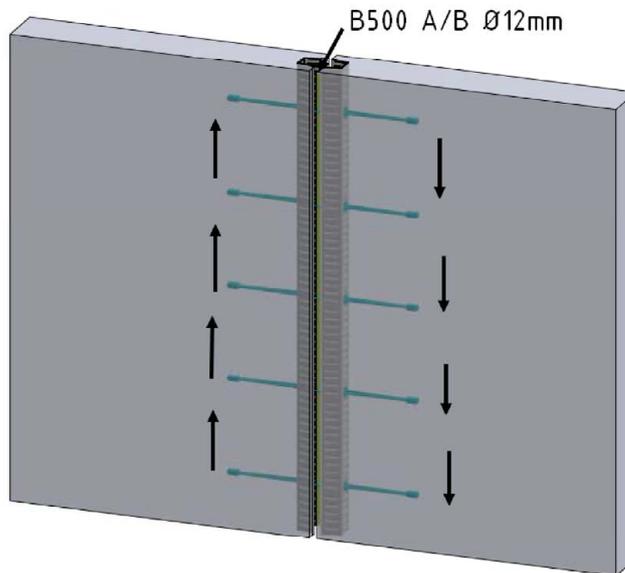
Beanspruchung parallel zur Fugenlängsrichtung
